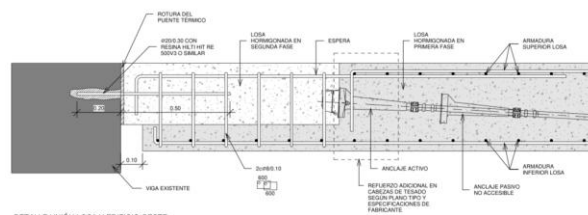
Detalle constructivo de apoyo de losa de hormigón postesado sobre la estructura de fachada
